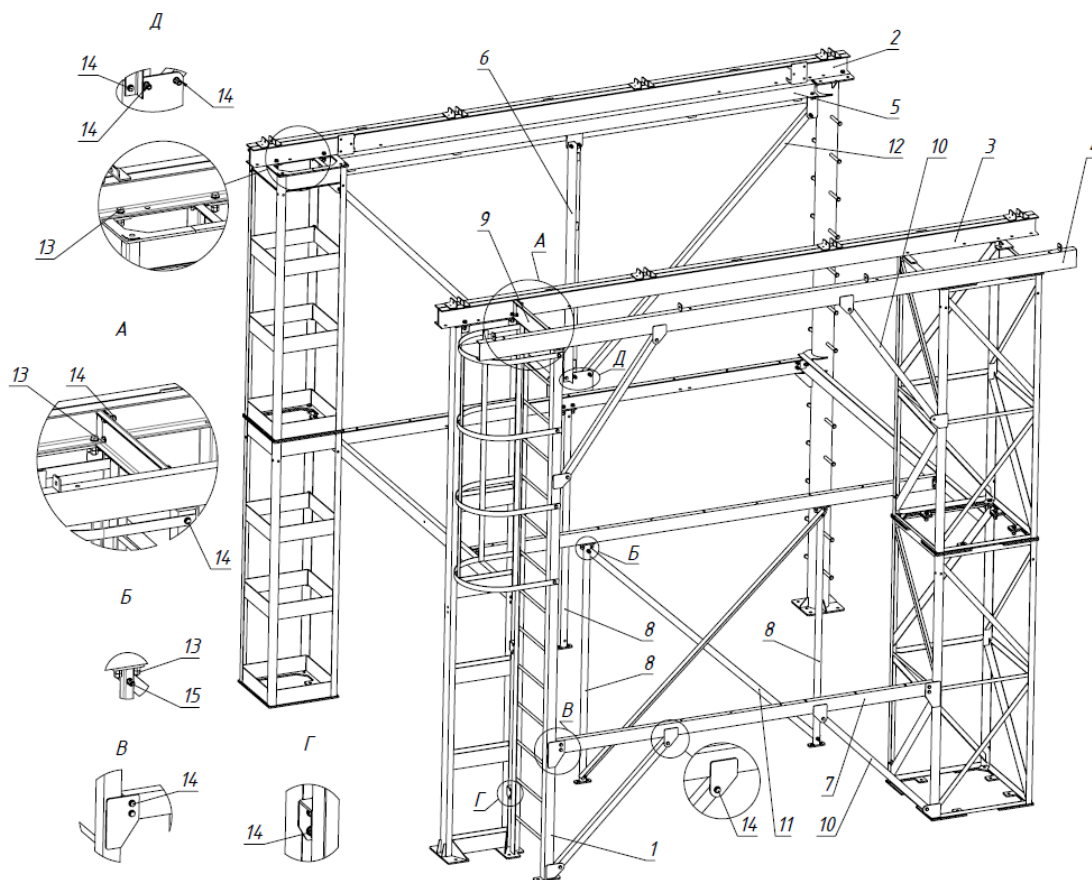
Сборка верхних балок. 1 – Лестница Л1, 2 – Балка Б1, 3- Балка Б2, 4 - Балка Б3, 5 – Распорка Рс2, 6 – Распорка Рс1, 7 – Балка Б9, 8 – Стойка С5, 9 – Связь СВ5, 10 – Связь СВ2, 11 - Связь СВ3, 12 - Связь СВ4, 13 – Болтокомплект А, 14 – Болтокомплект Б, 15 – Болтокомплект Г, 16 – Шпилечный комплект А (на рис. условно не показан).
